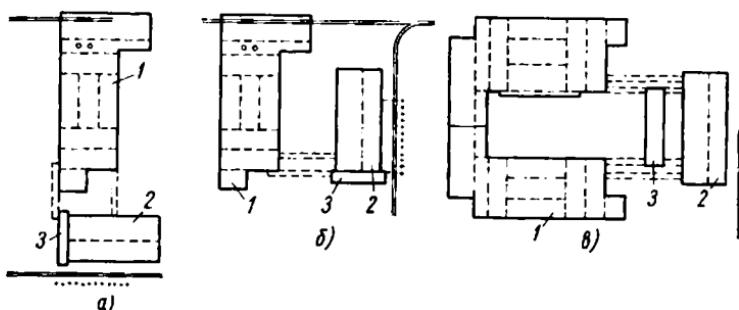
Схемы блокировки литейных корпусов и корпусов для обрубки отливок:
